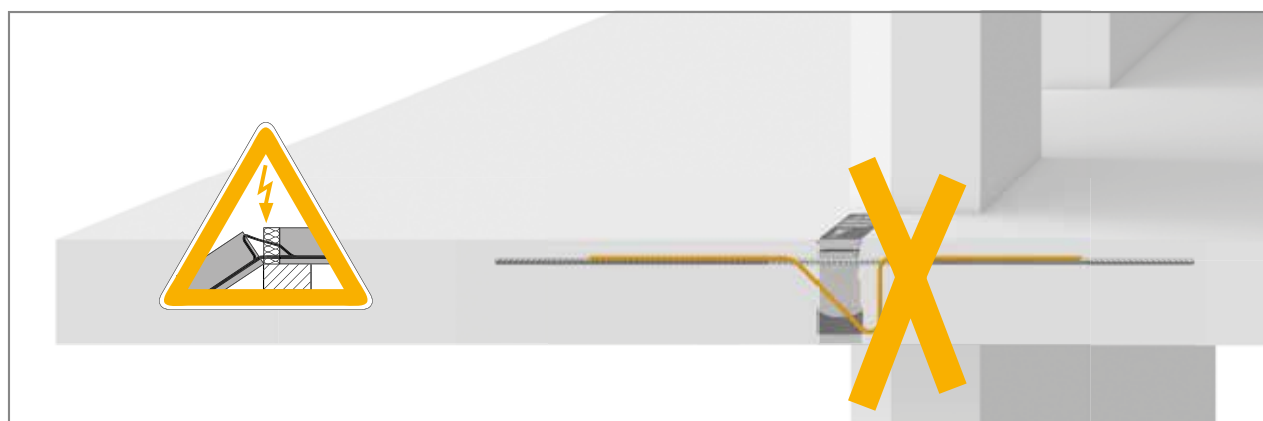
Schöck Isokorb® tipo K, se non montato correttamente la barra a taglio è posizionata obliquamente dall'alto (lato del balcone) al basso (lato del solaio)
